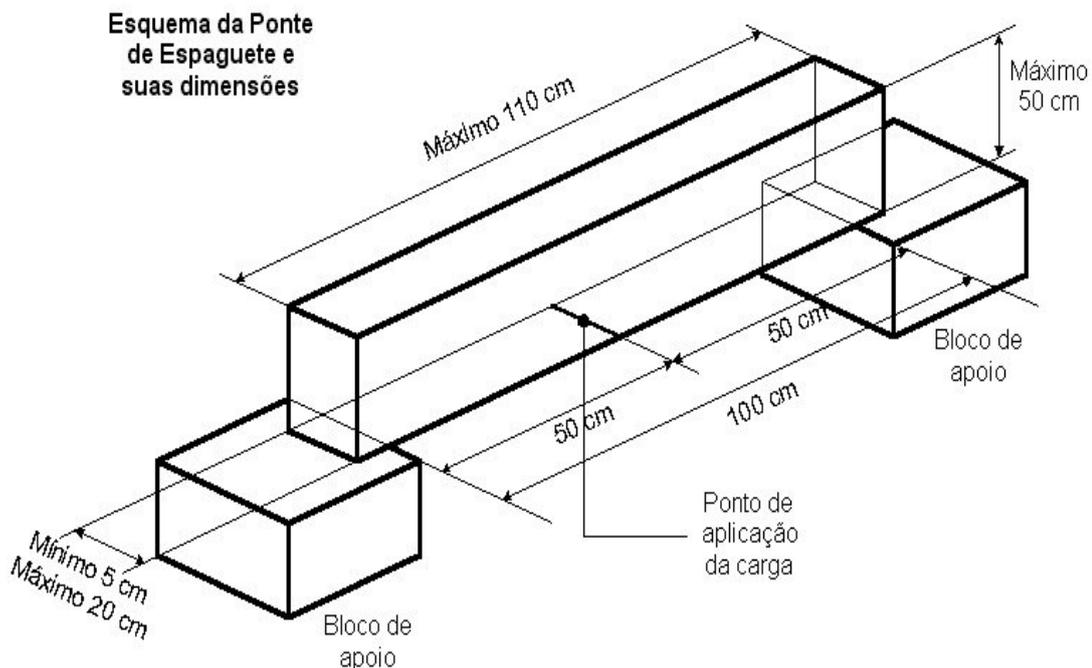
Desenho esquemático da bancada para ensaio da ponte de espaguete e suas dimensões (UFRGS, 2008).
